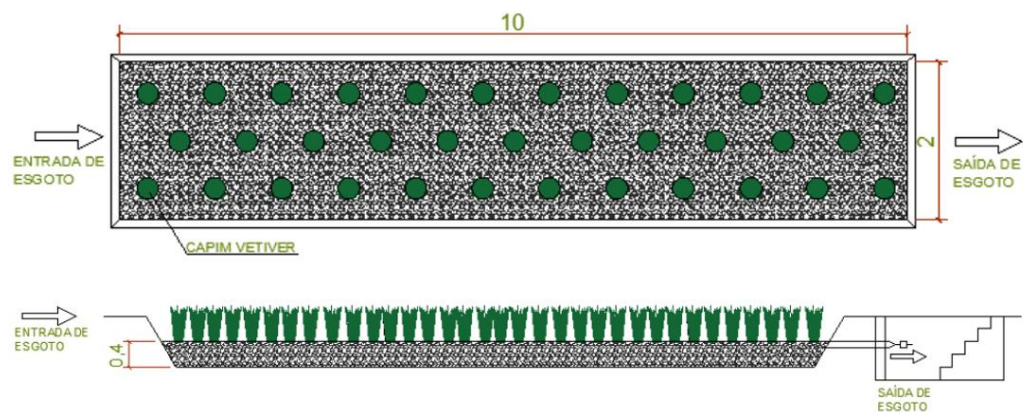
Planta baixa e perfil longitudinal do WC-FSSH.
